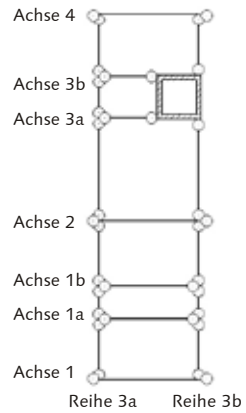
Grundriss Gelenk I - Erschließung
